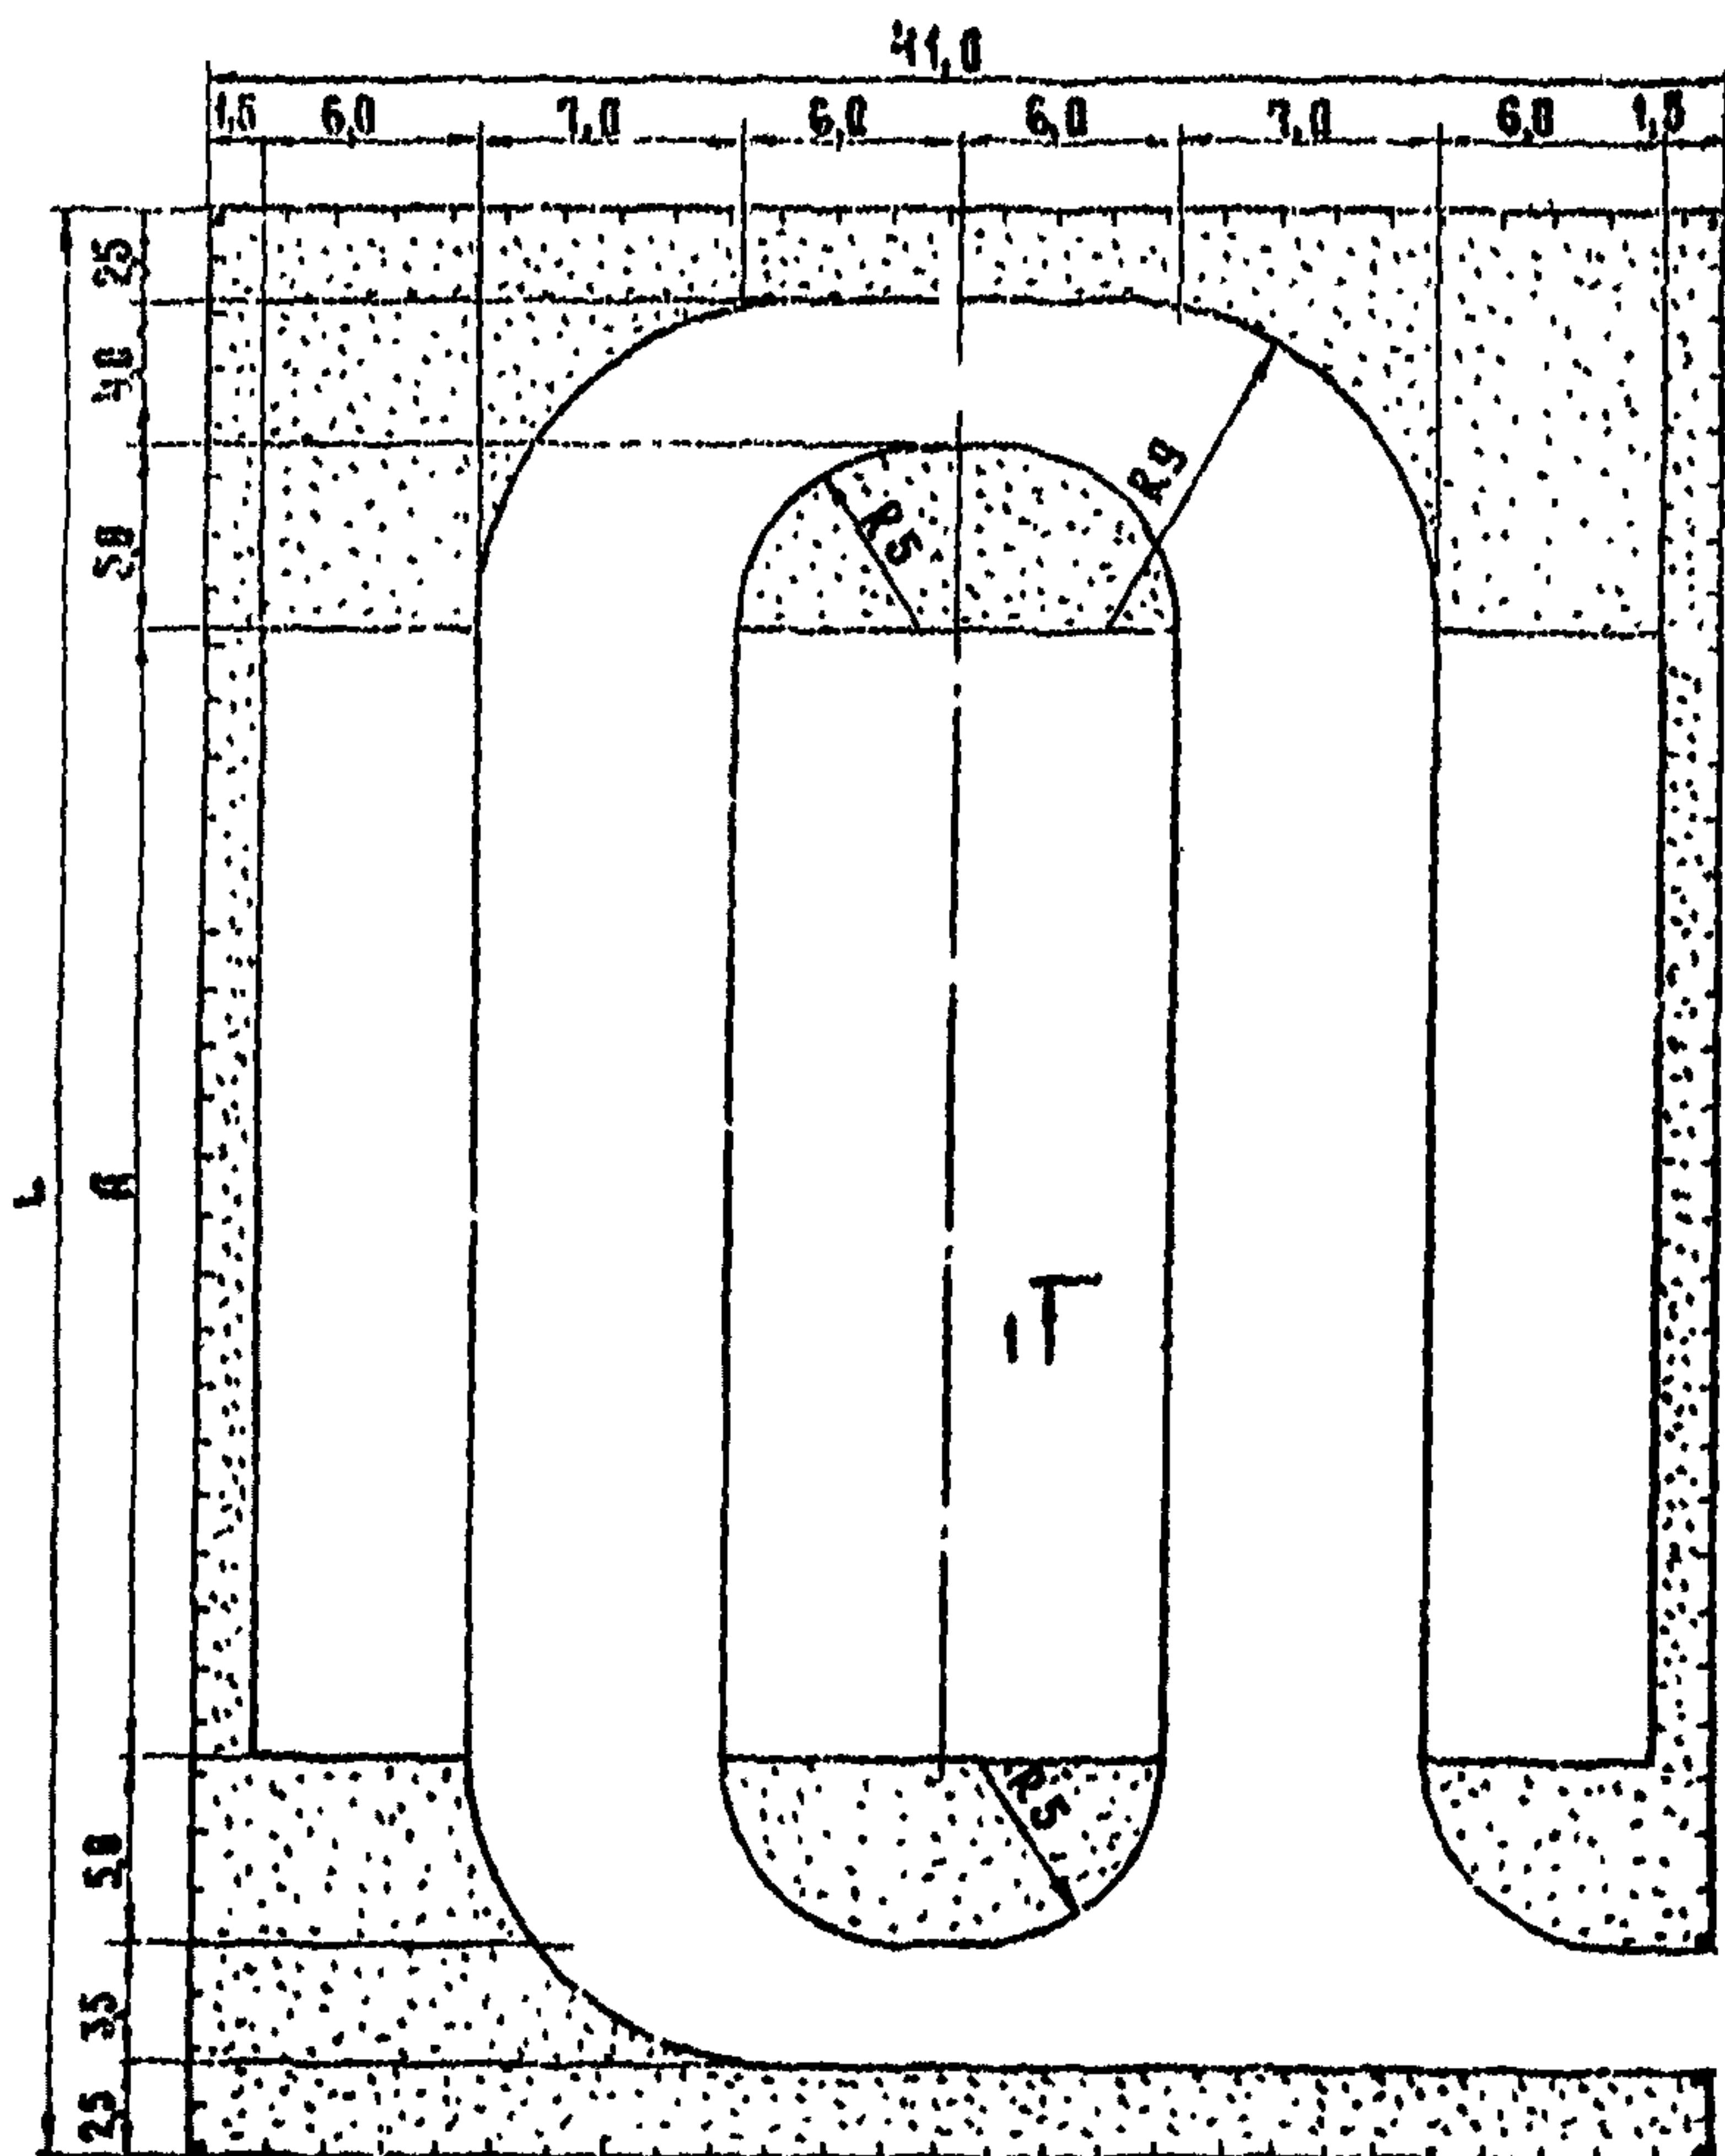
Схема генерального плана хранения на 800-3200 т с использованием на погрузочных работах автокрана КС-256Д.
